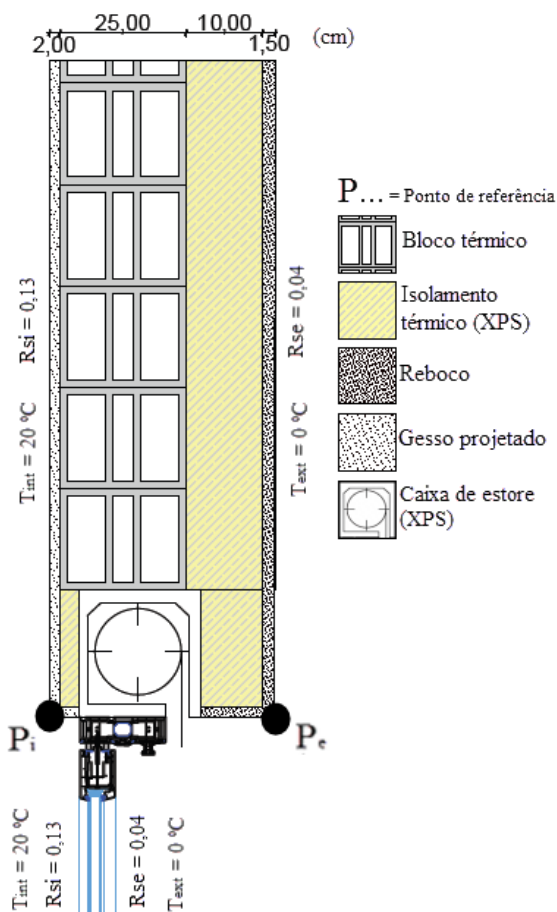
Ligação fachada (parede simples) e caixa de estore/padieira
